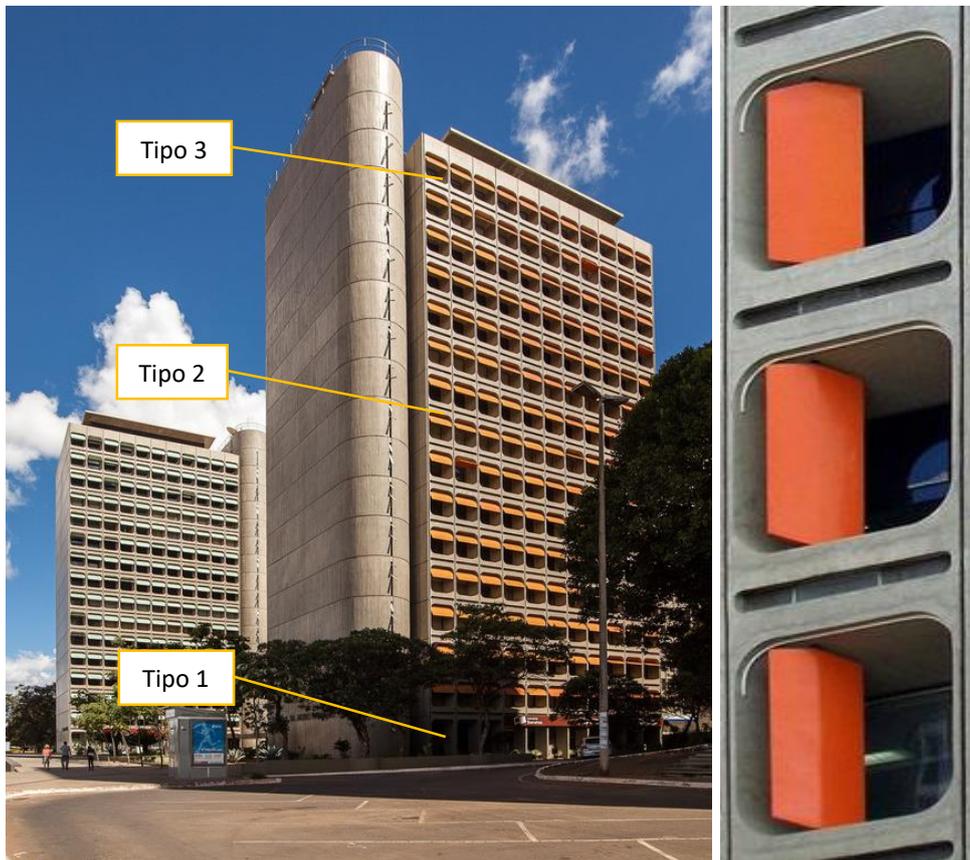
Vista de diseño y detalles de los tres tipos de cajas prefabricadas en fachada
